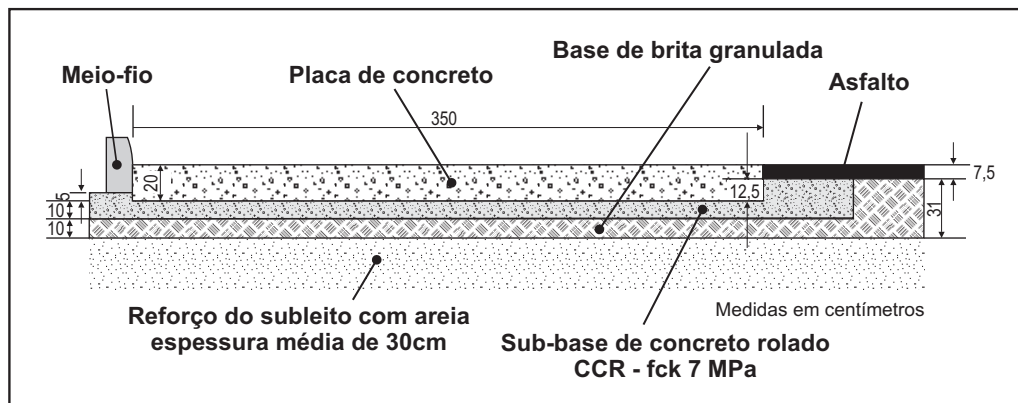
Seção transversal do pavimento rígido da parada de ônibus – Av. Juca Batista
